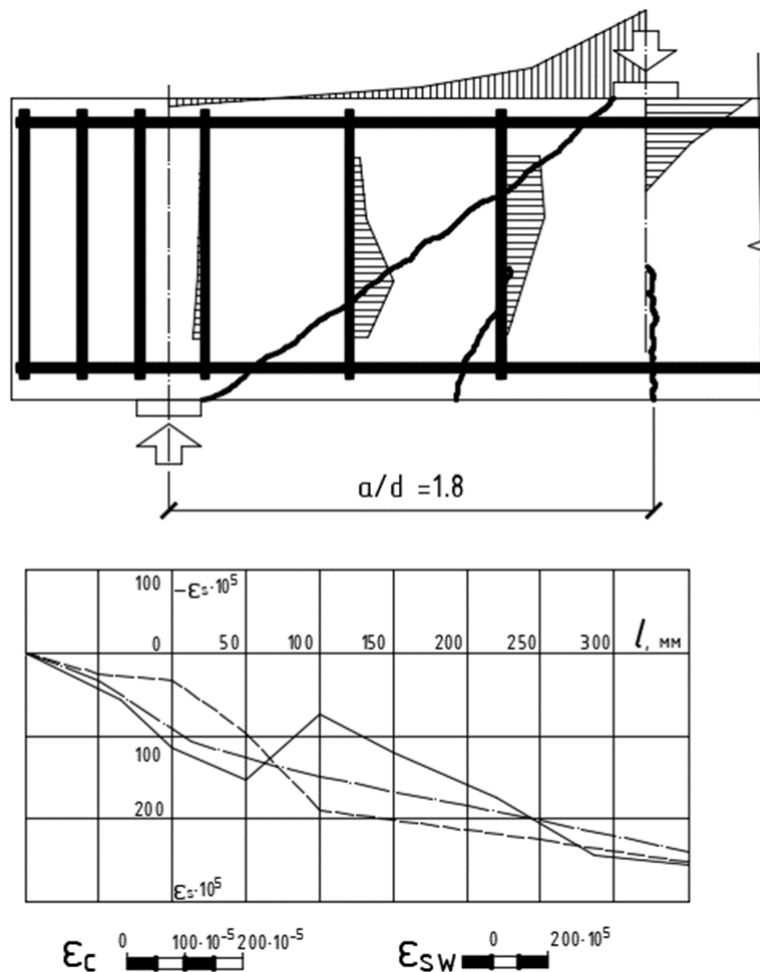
Напружено-деформований стан бетону, поздовжньої і поперечної арматури балок 2 серії (з поперечною арматурою)
